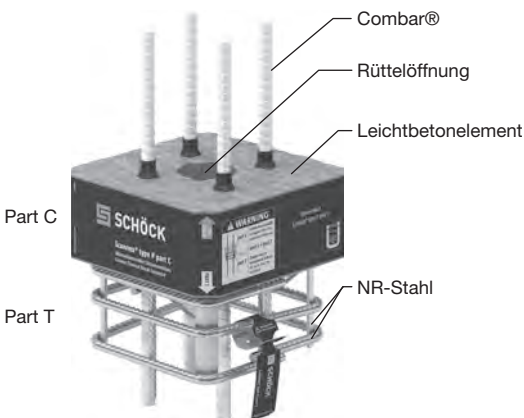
Wärmedämmender Stützenanschluss Schöck Sconnex® Typ P
